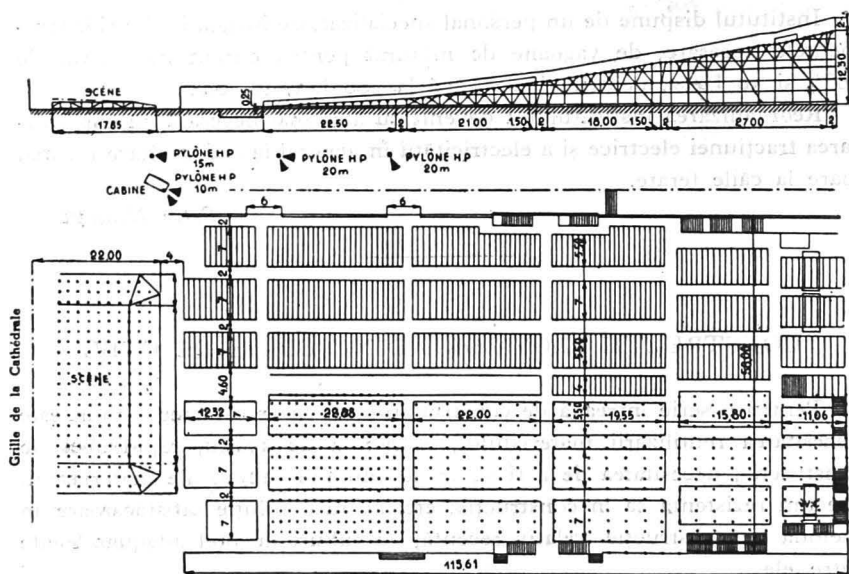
Coupe et plan de la tribune qui occupait entièrement le parvis Notre-Dame.
